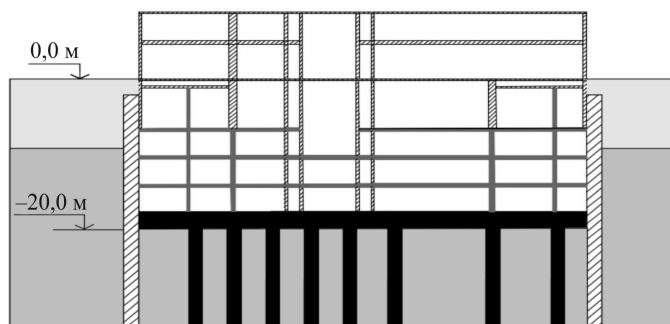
Порядок производства работ по методу «Тор-Down» на 4-м этапе: бетонирование фундаментной плиты; завершение этажа -5; возведение этажей 1-4; остановка водопонижения; продолжение монолитных работ до n -го этажа
